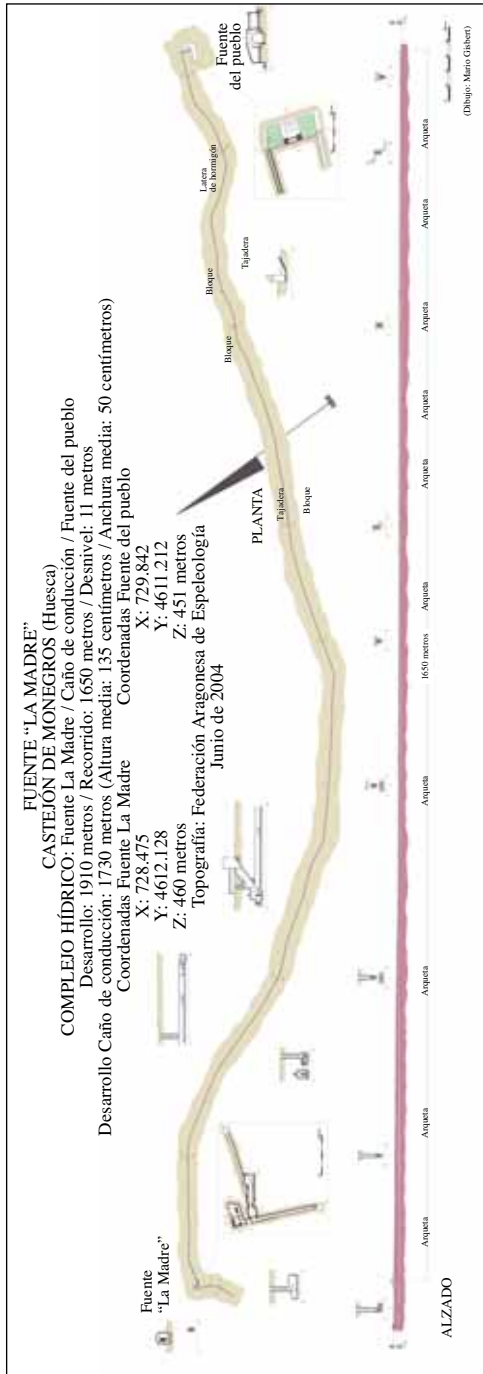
Planta de La Madre y caño de Castejón de Monegros con secciones.
